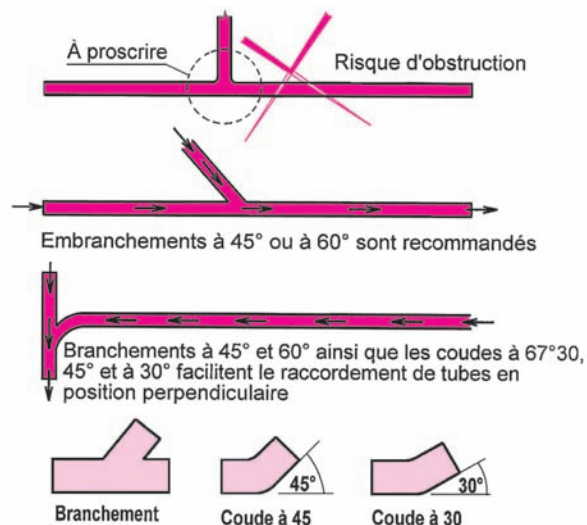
Préconisations et accessoires de raccordement à des collecteurs principaux d'allure horizontale
